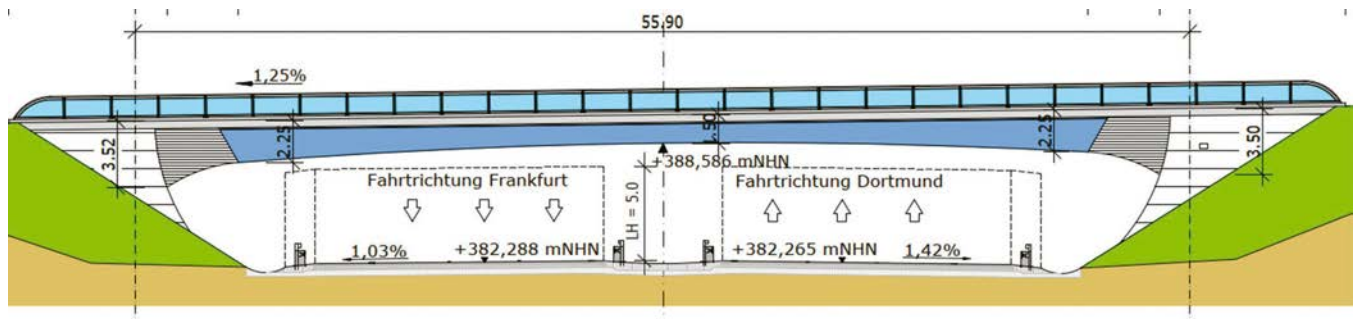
Variante 1 – Stahlverbundbrücke als Rahmentragwerk (Quelle: Doser Kempen Krause Ingenieure)
